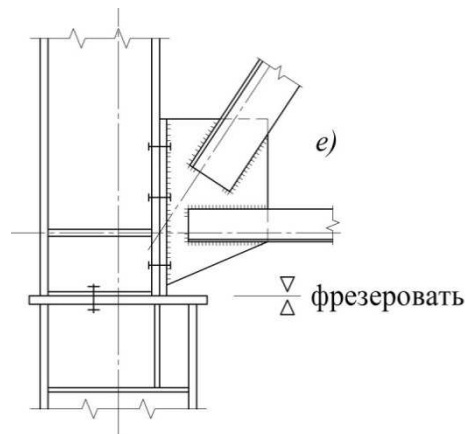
е. Вариант опорного нижнего узла фермы с применением надколонника
